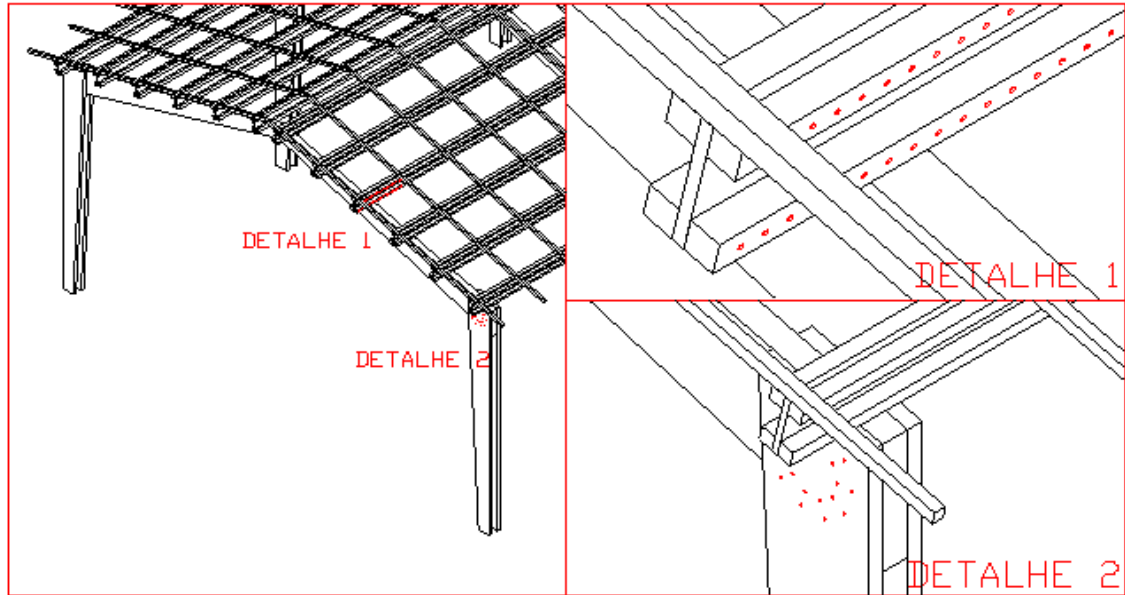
Aplicações das ligações mecânicas em estruturas de madeira.
